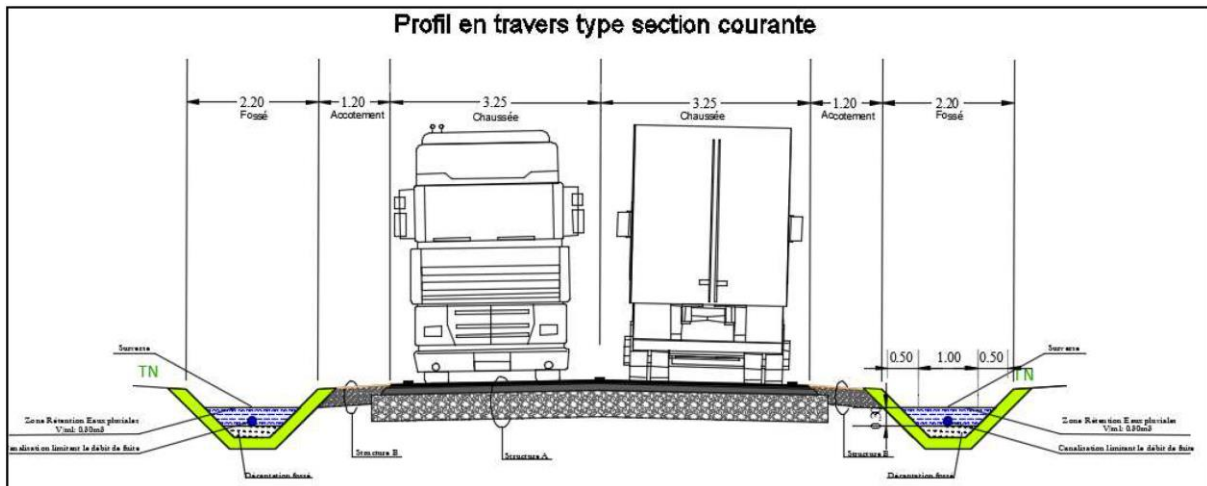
Profil en travers de la nouvelle voie type section courante (Source : SODEREF)
